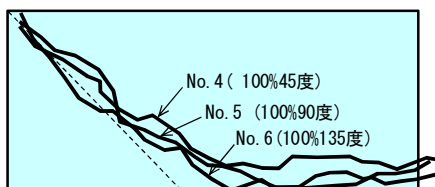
せん断ひび割れ位置 (試験番号 4~6)
